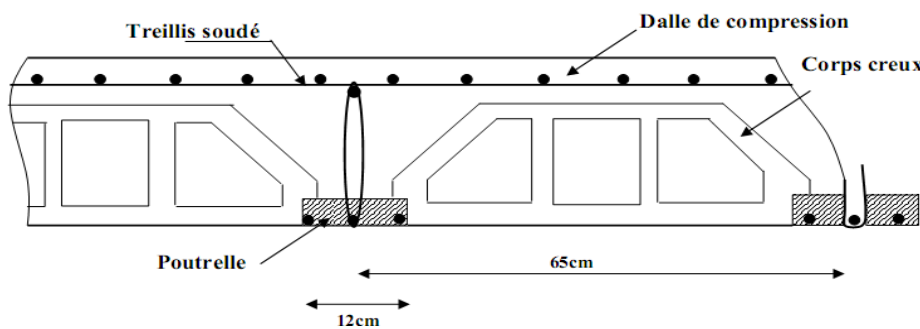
Coupe verticale d'un plancher en corps creux. Figure III.4.2 : Poutrelle.
